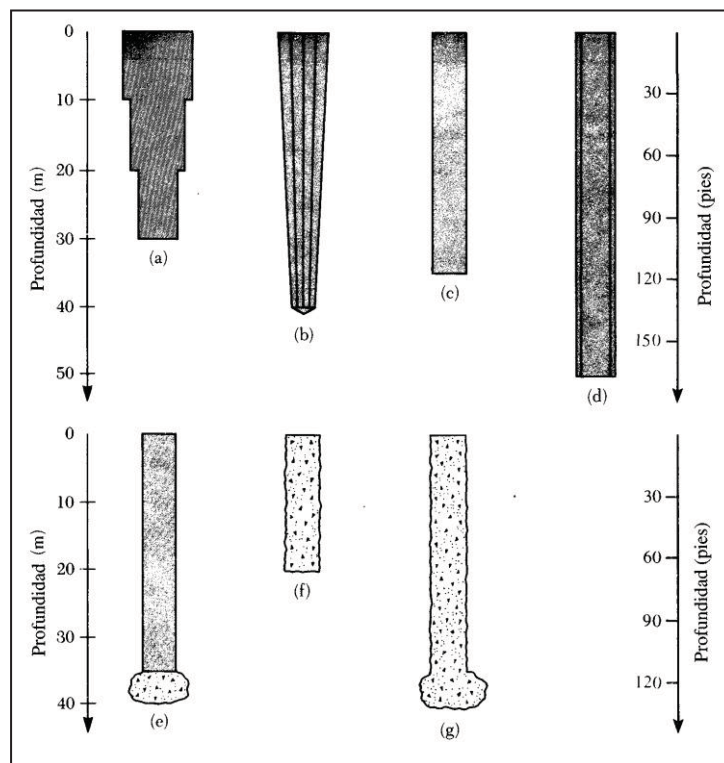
Pilotes de concreto. (Fuente: Braja M. Das, 2001, pág. 569).
